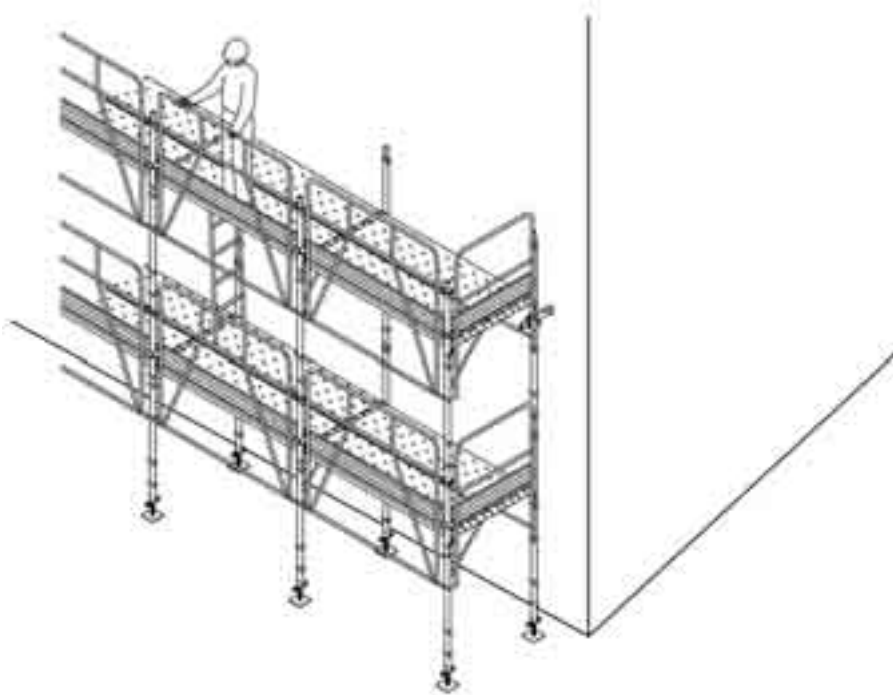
Fasi di montaggio dal basso del ponteggio con parapetto di protezione collettivo
